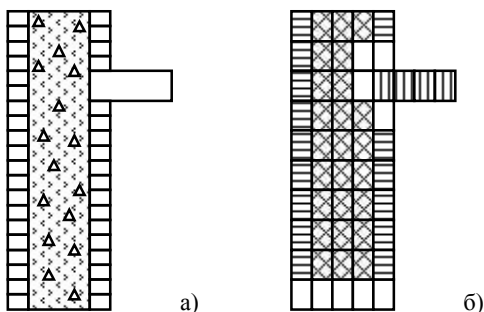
Фрагмент узла опирания панели перекрытия на простенок (а) и его представление в МКЭ (б).
